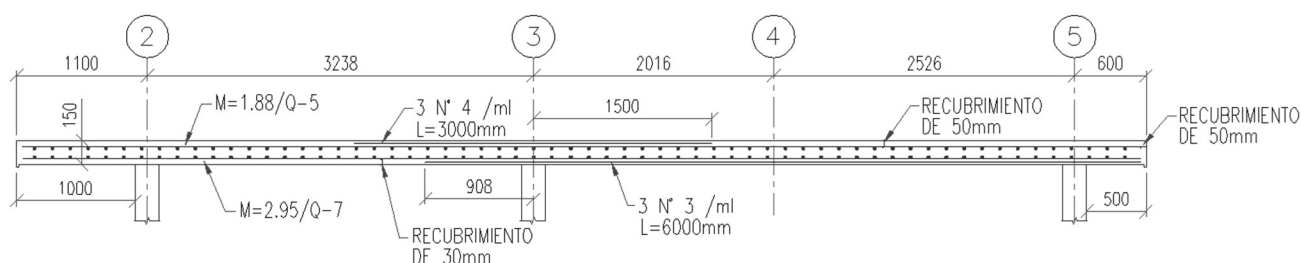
Detalle distribución de refuerzo extraído de plano de diseño (archivo propio)
